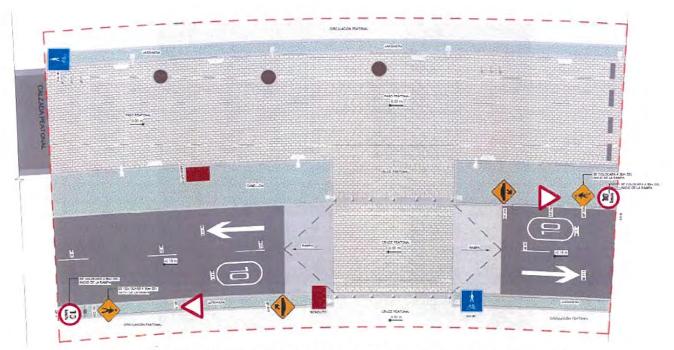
Planta general de la ubicación de la señalización vertical y horizontal.
